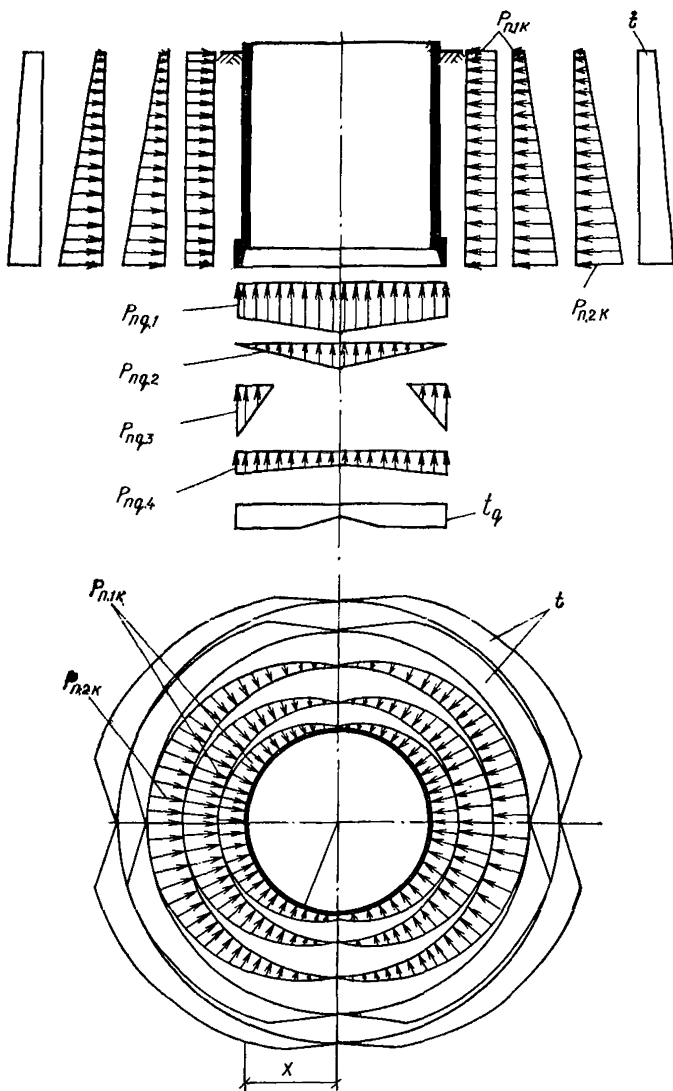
Схемы круглого колодца с расчетными дополнительными нагрузками, вызванными подработкой основания
